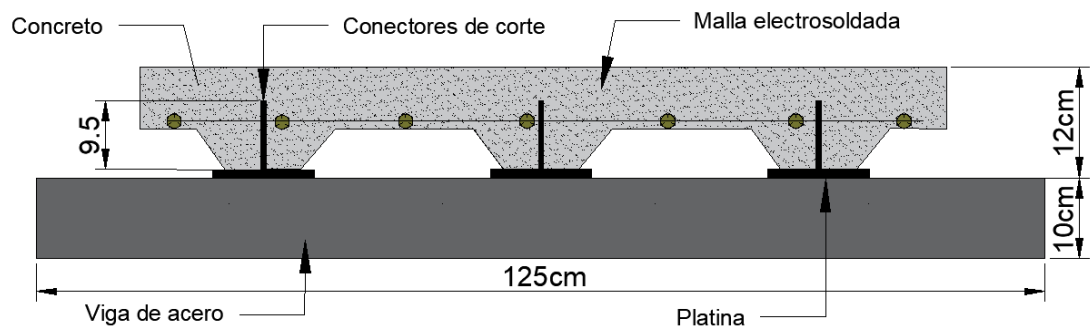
Sección Compuesta, conector de corte tipo varilla
